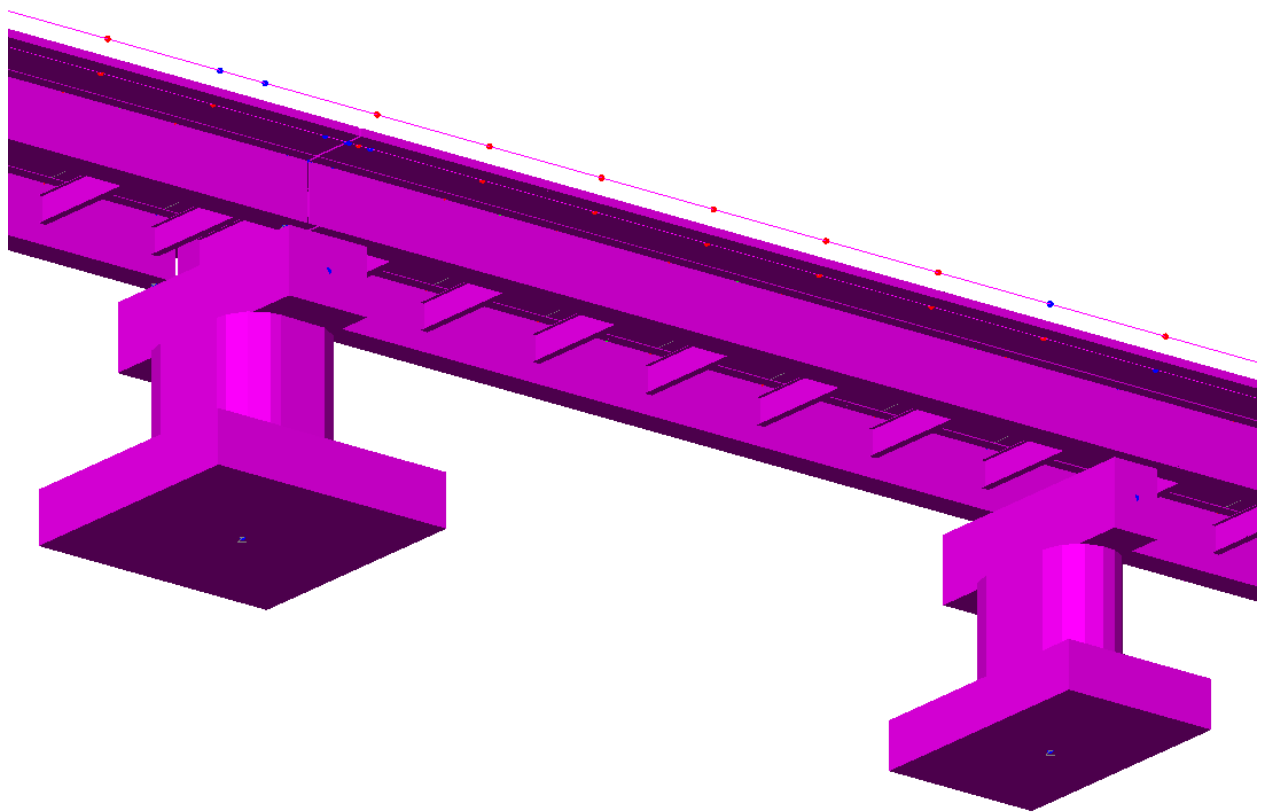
Modello FEM in fase 3 - Particolare zona di testa pila
